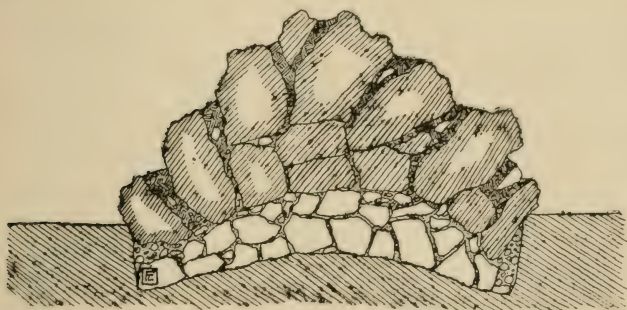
Construction (coupe) d'une rocaille en terrain plat.
